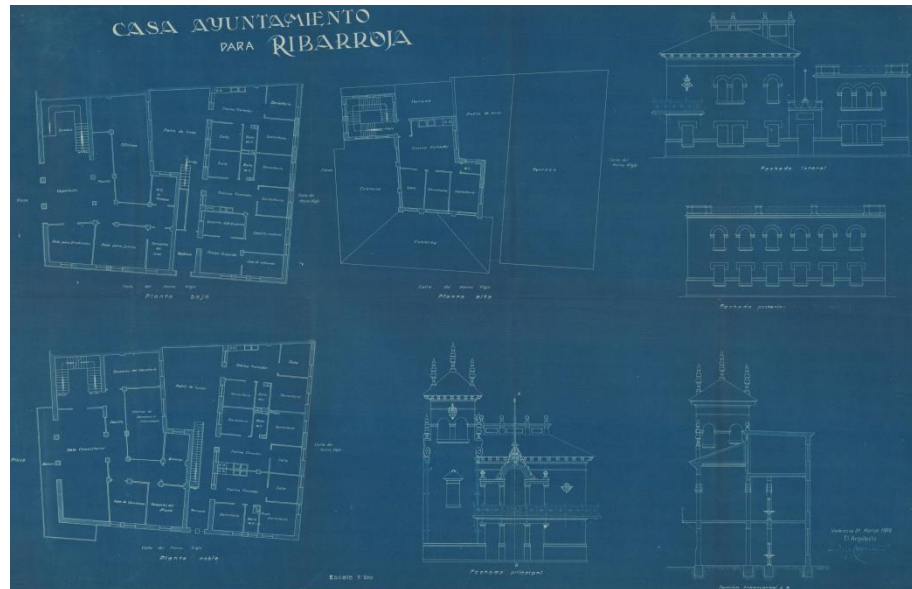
Lámina que incluye los planos Ayuntamiento de Ribarroja
